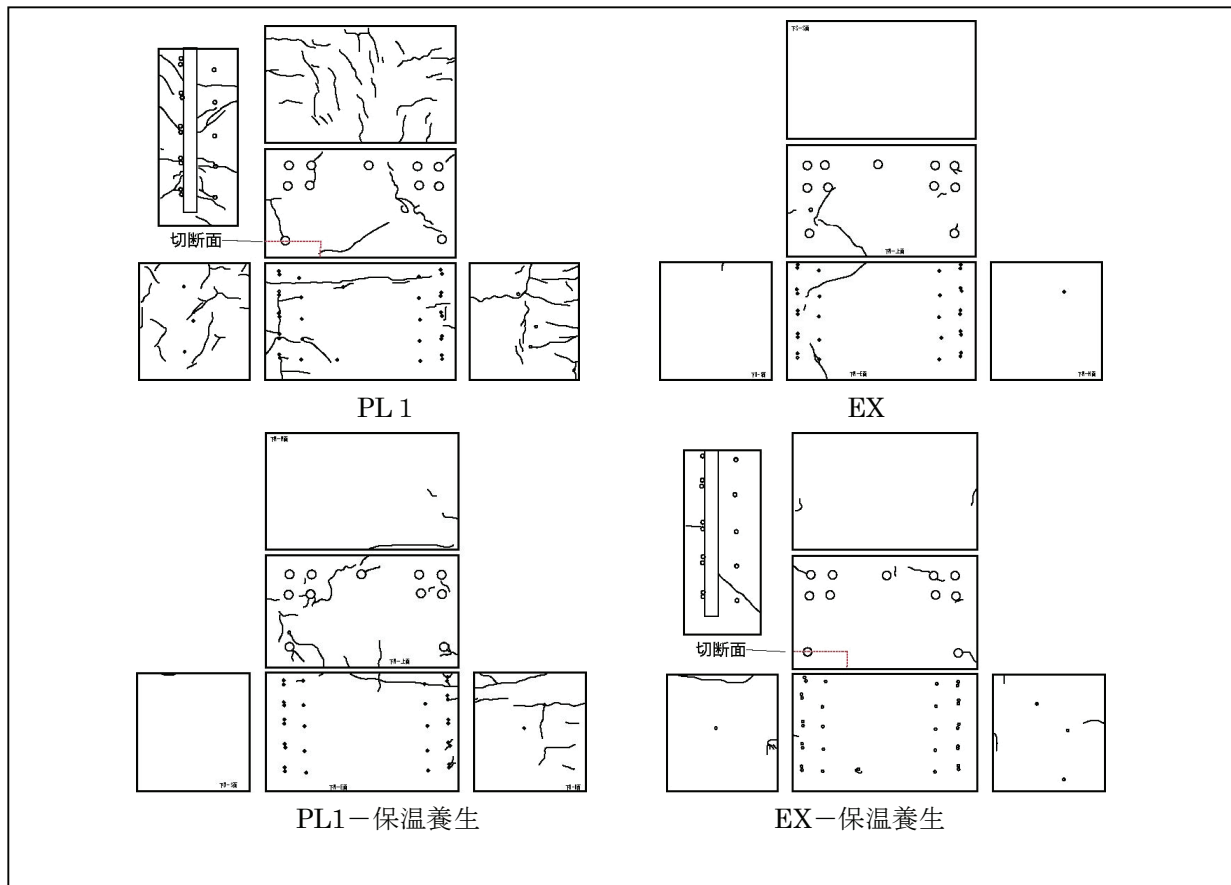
ひび割れ状況の一例 (シリーズ1)
